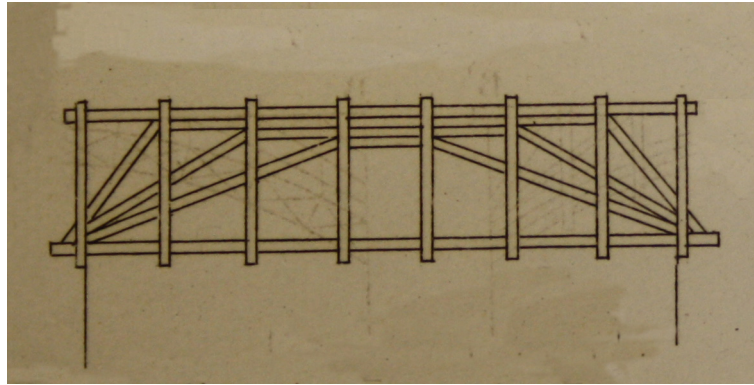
Struttura di ponte con un tirante che assorbe le spinte orizzontali dell'impalcato sulle spalle.
